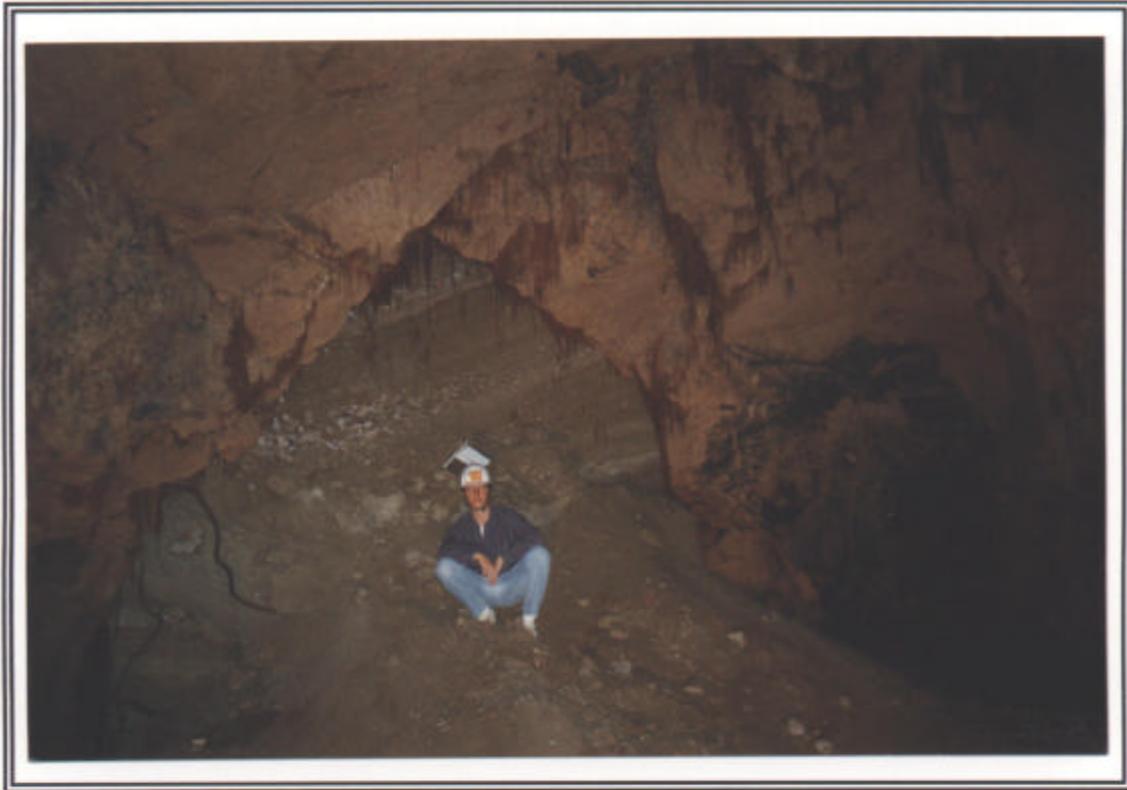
Camino verticale completamente riempito di terreno di riporto sotto Piazza Albina
